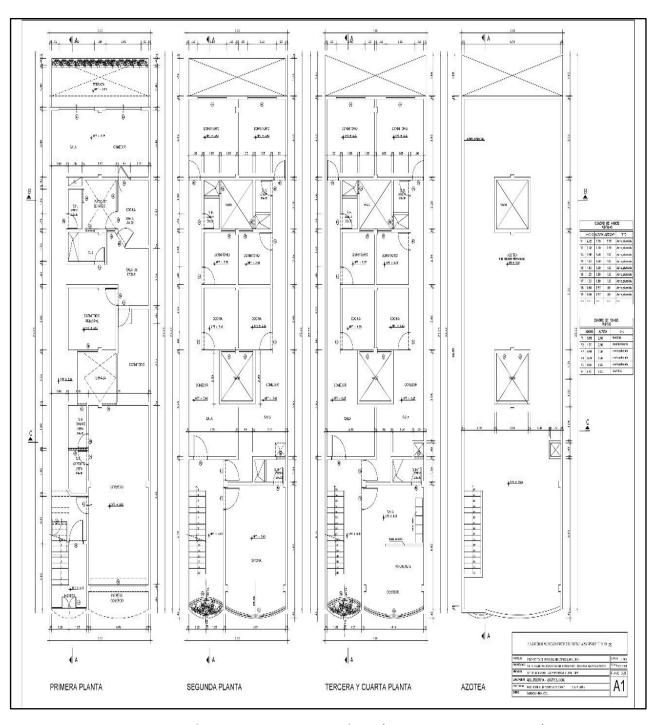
Esquema de arquitectura, vista en planta (Fuente Arq.Diego Moreno)
